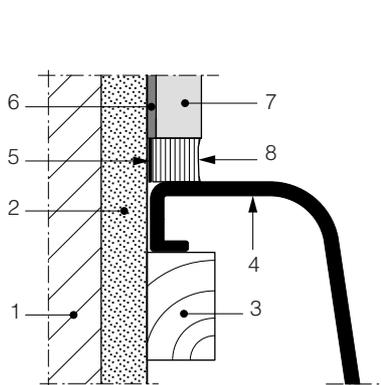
Exemple de joint souple avec bande de fond de joint de faible épaisseur.
